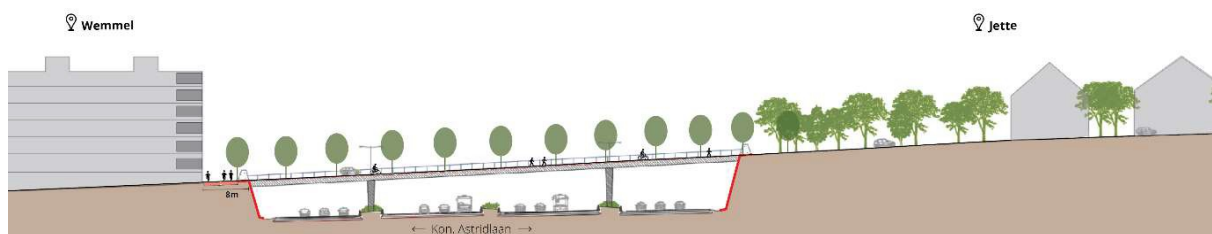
Coupe G2A1 - Profil longitudinal réduit - Avenue R. Astrid
